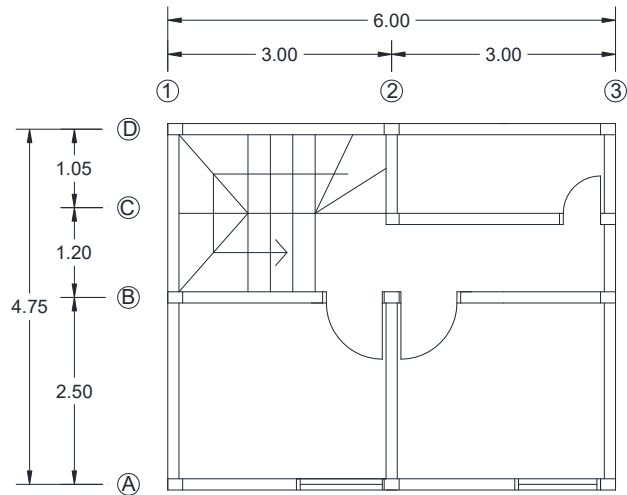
Denah rumah tinggal tipe 45 extension lantai 1
